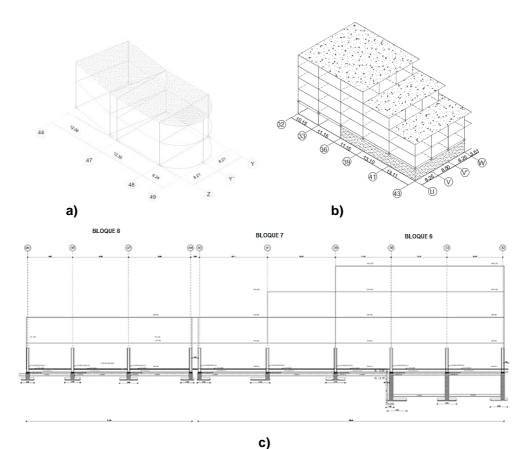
Bloque Estructural Dos, compuesto por los Bloques Arquitectónicos: a) Ocho de dos pisos; b) Bloques 7 y 6; c) Vista del Bloque Estructural dos.
